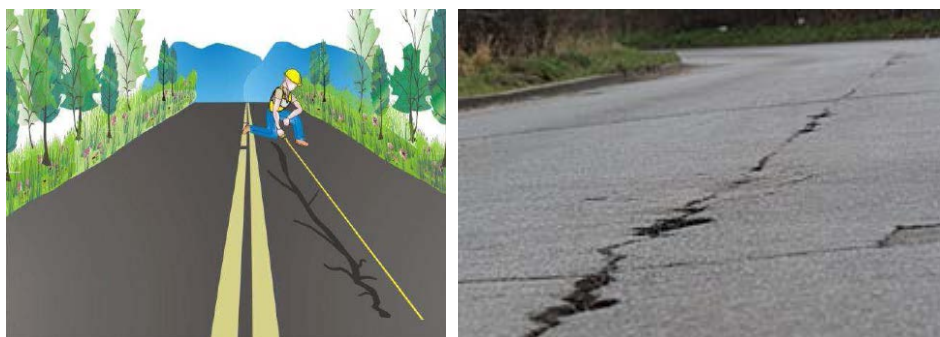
Apariencia de un pavimento afectado por grietas longitudinales.
